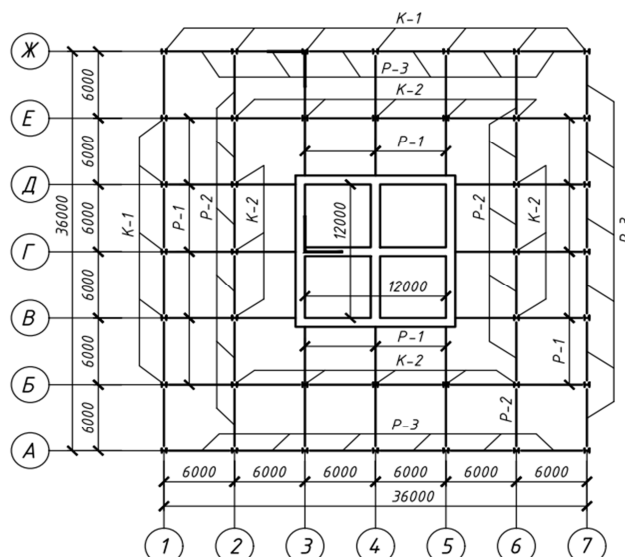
Схема расположения несущих конструкций высотного здания ствольно-каркасной конструктивной схемы: К-1, К-2 – колонны каркаса; Р-1, Р-2, Р-3 – ригели каркаса
